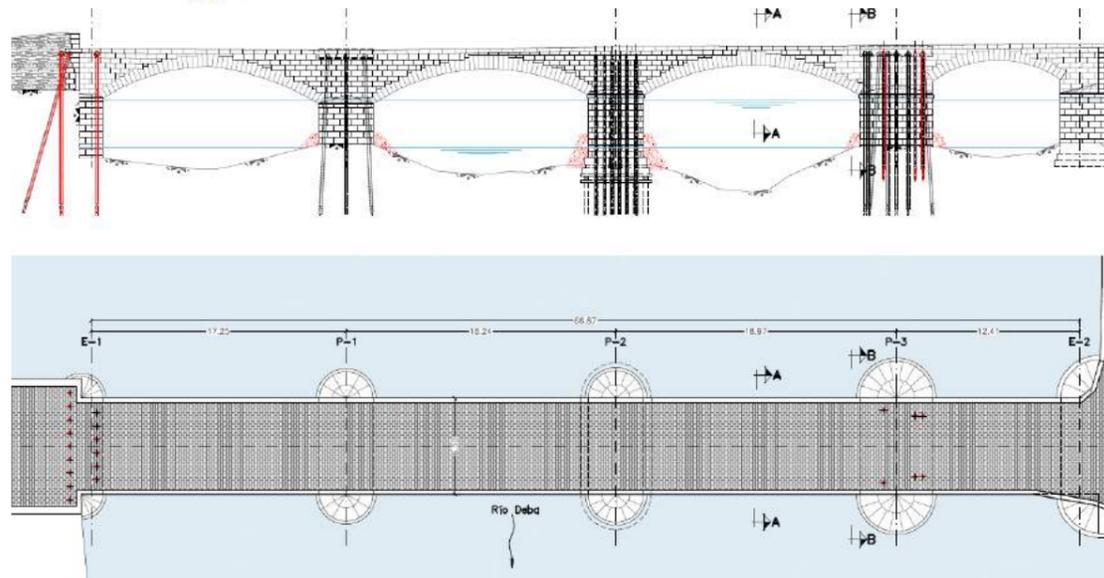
Recalces en estribo 1 y pila 3, y protección de cimentaciones
